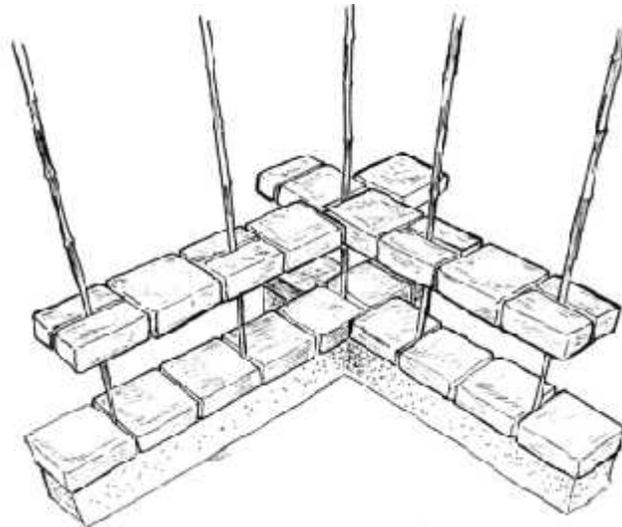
Primer hilada de paredes de adobe cuadrado
